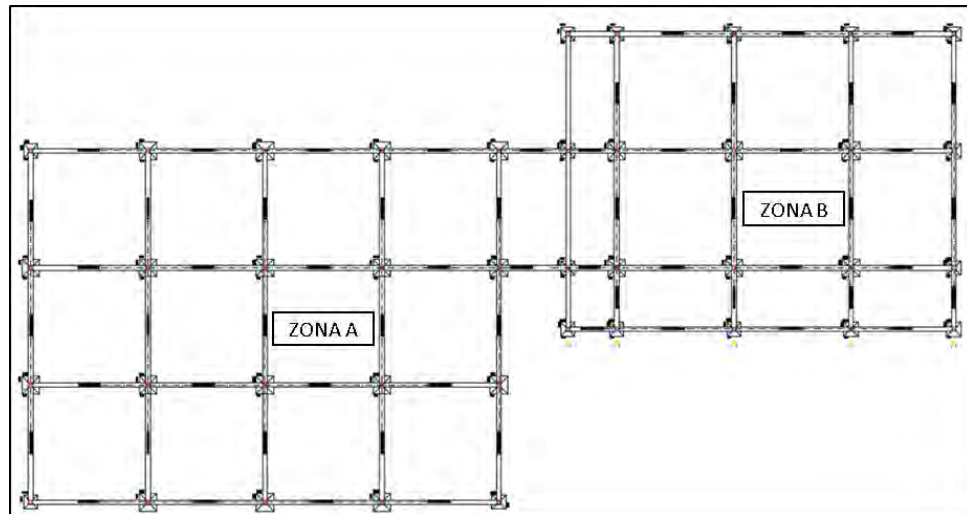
Planta de cimentación de la plaza de mercado El Achiote
